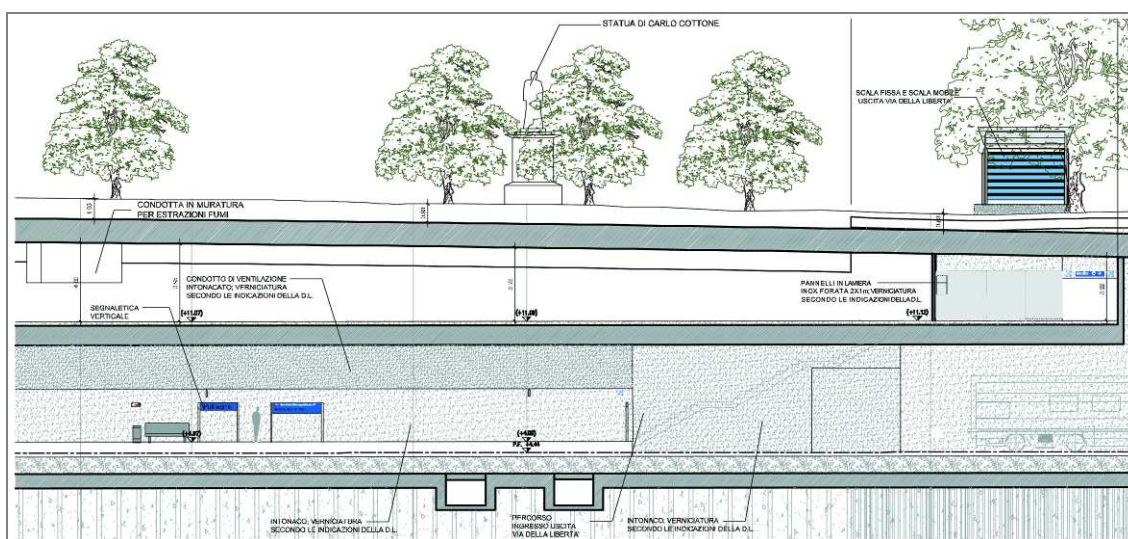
Sezione longitudinale della banchina e del piano mezzanino
